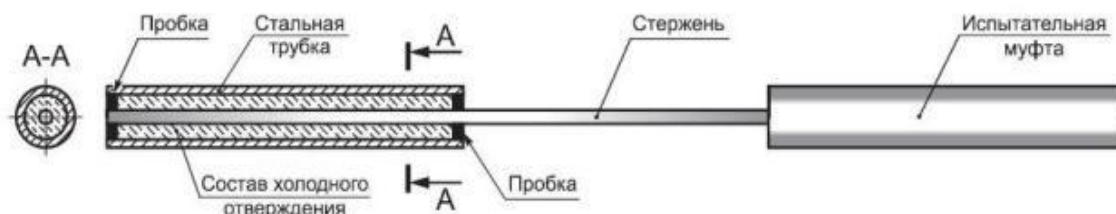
Схема сборки опытного образца стержня композитной арматуры
